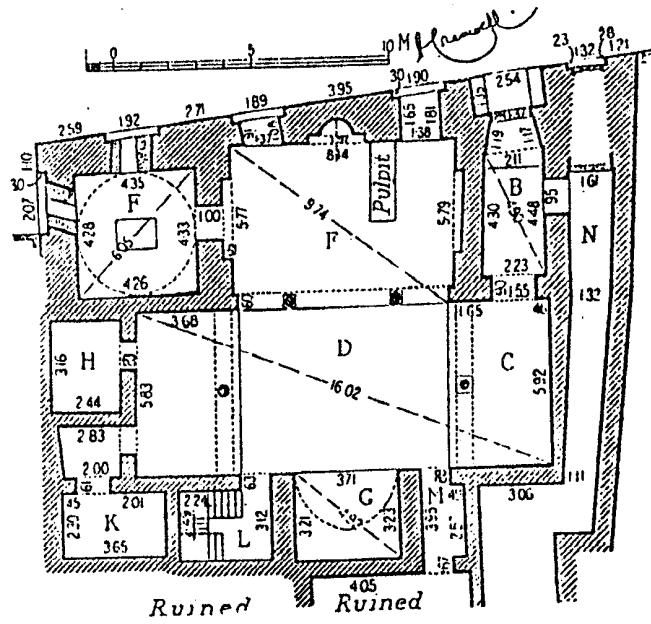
مكرر) مسقط أفقي لمسجد جبل سيس (عن : Creswell)
